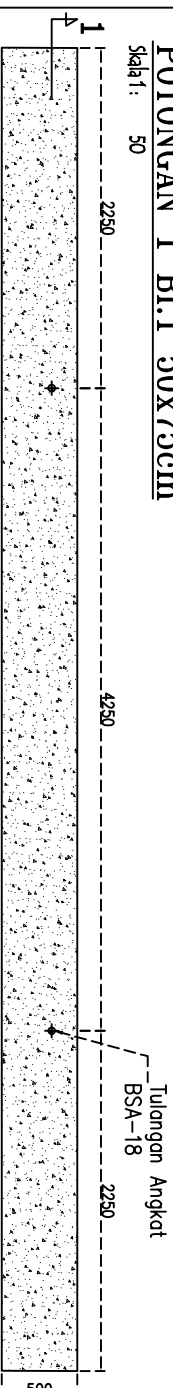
DETAIL TULANGAN ANGKAT BALOK BI.1 50x75 cm
